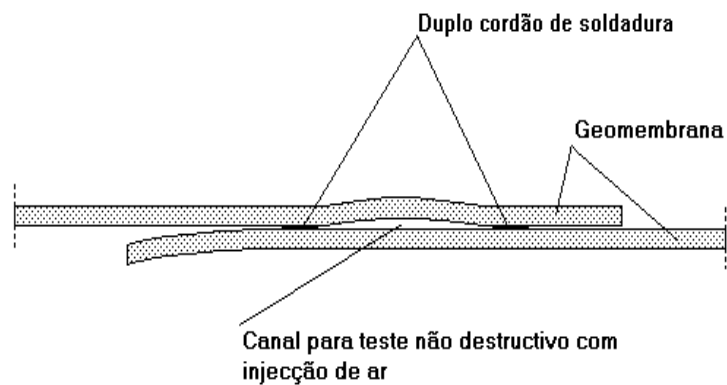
Representação esquemática de uma soldadura dupla com o canal de comprovação de estanquicidade.
